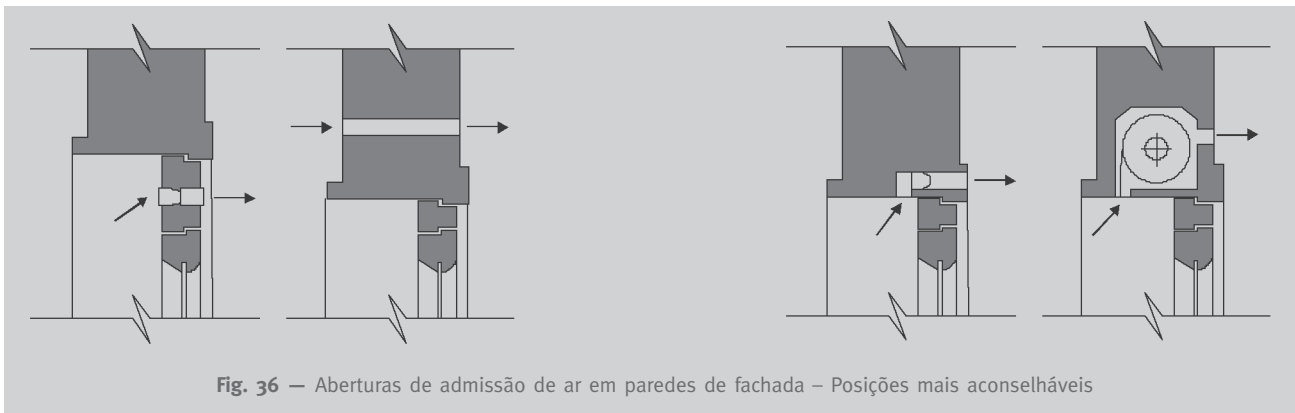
Aberturas de admissão de ar em paredes de fachada — Posições mais aconselháveis
